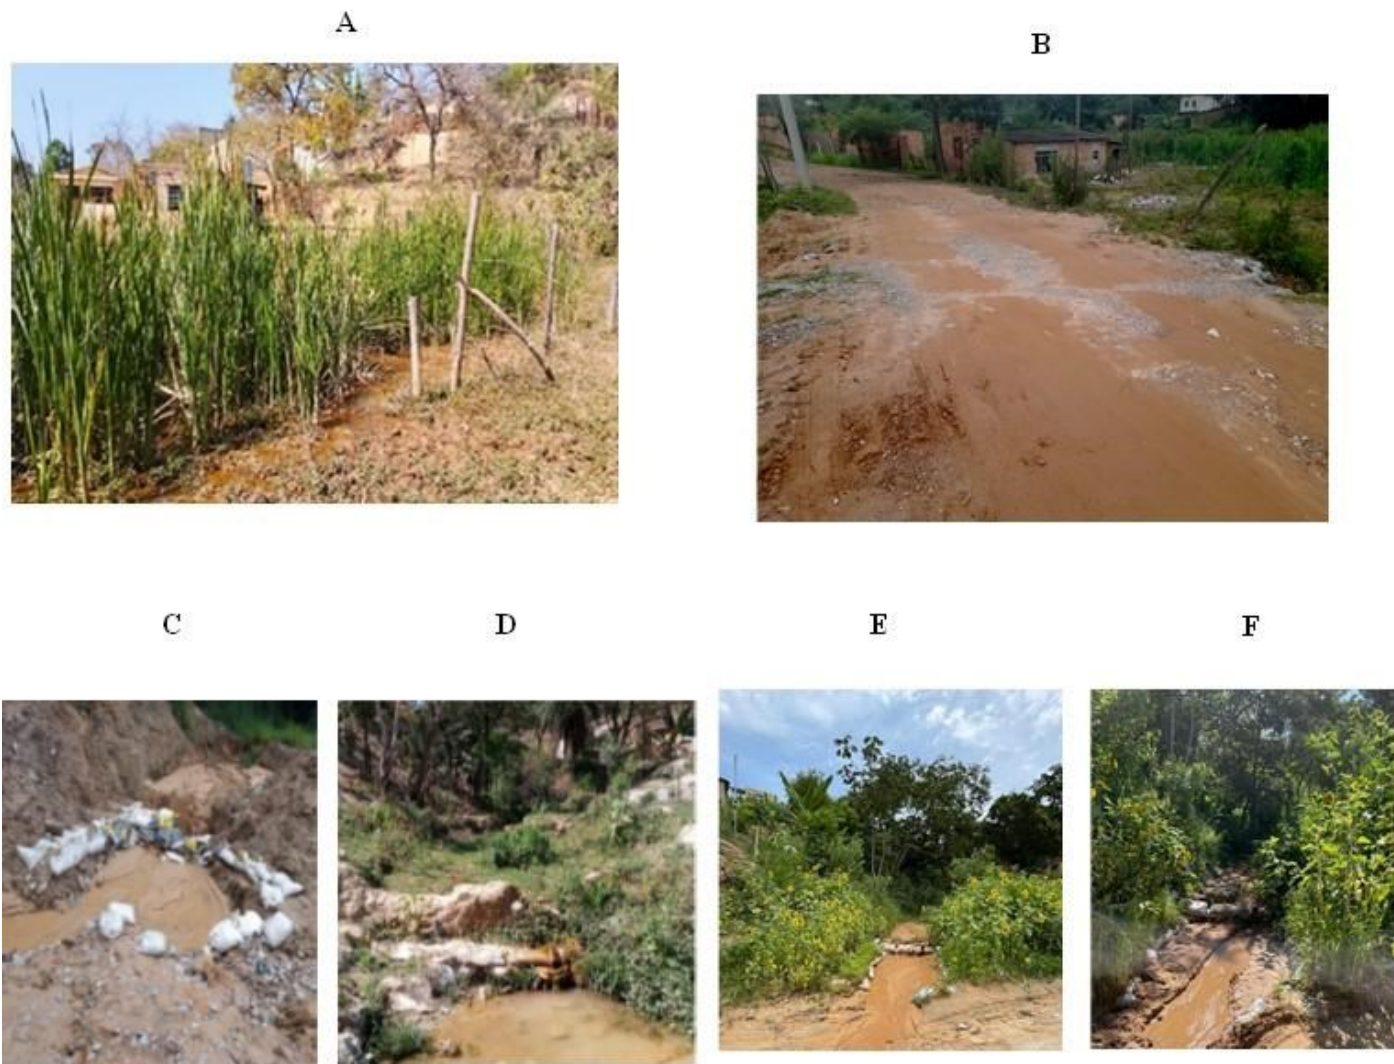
Nascente N2 Trecho da Av. Jacarandá antes (A) e após intervenção. (B) Barragem N2. C: Construção da barragem em dezembro/janeiro de 2021/2022. D: Barragem, em abril de 2023. E e F: Barragem, em Janeiro de 2024.
